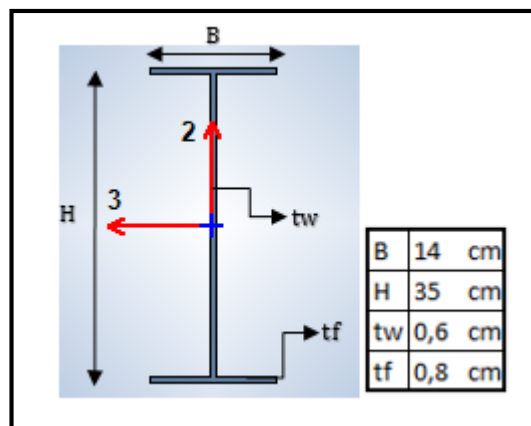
Dimensiones de Vigas centrales en “Y” con pórticos resistentes a momento, planta de cubierta.
